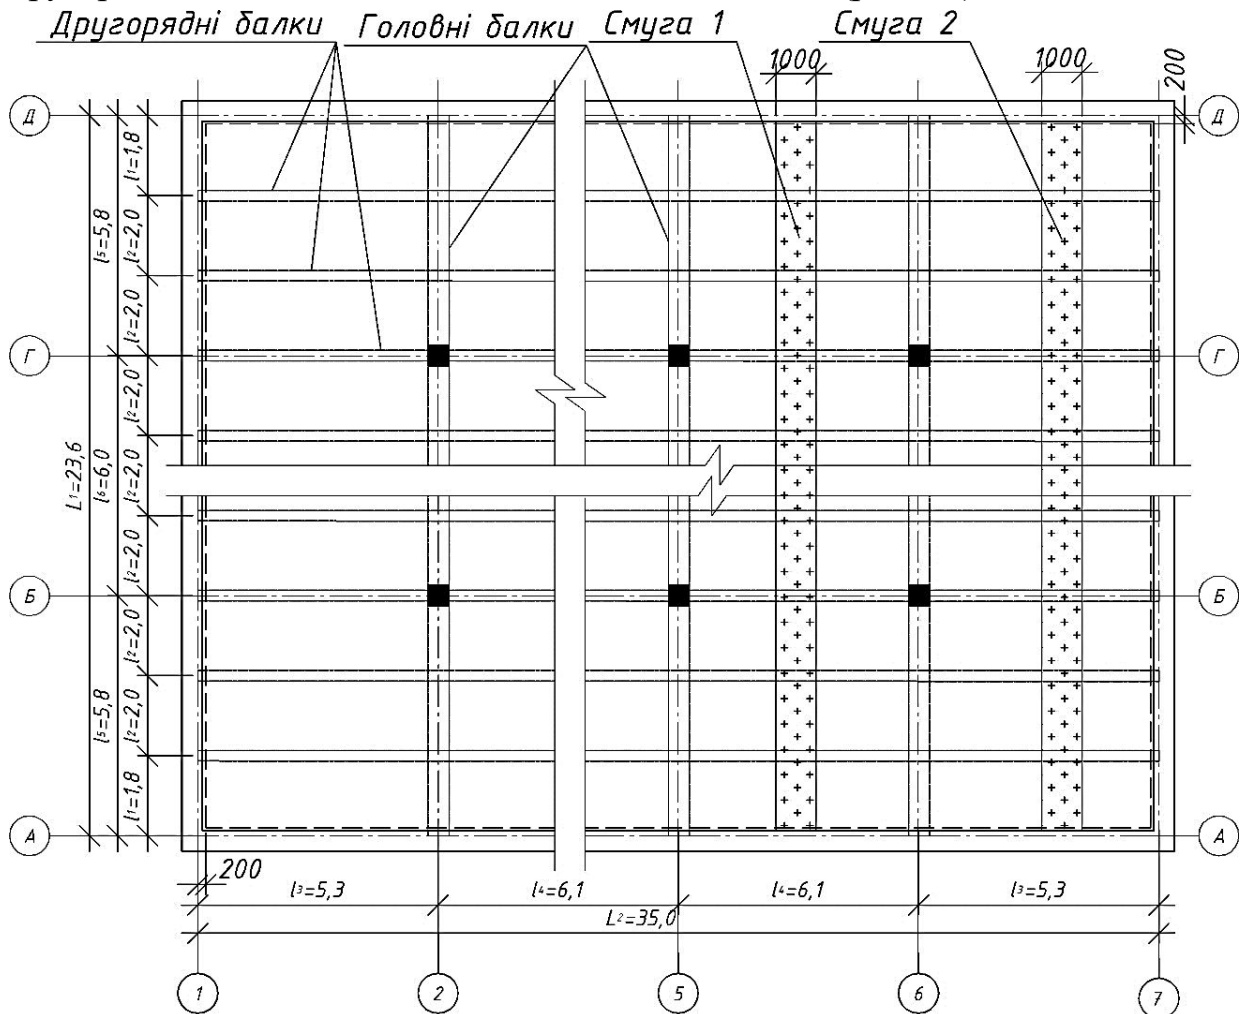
Конструктивна схема перекриття з поперечним розташуванням головних балок
